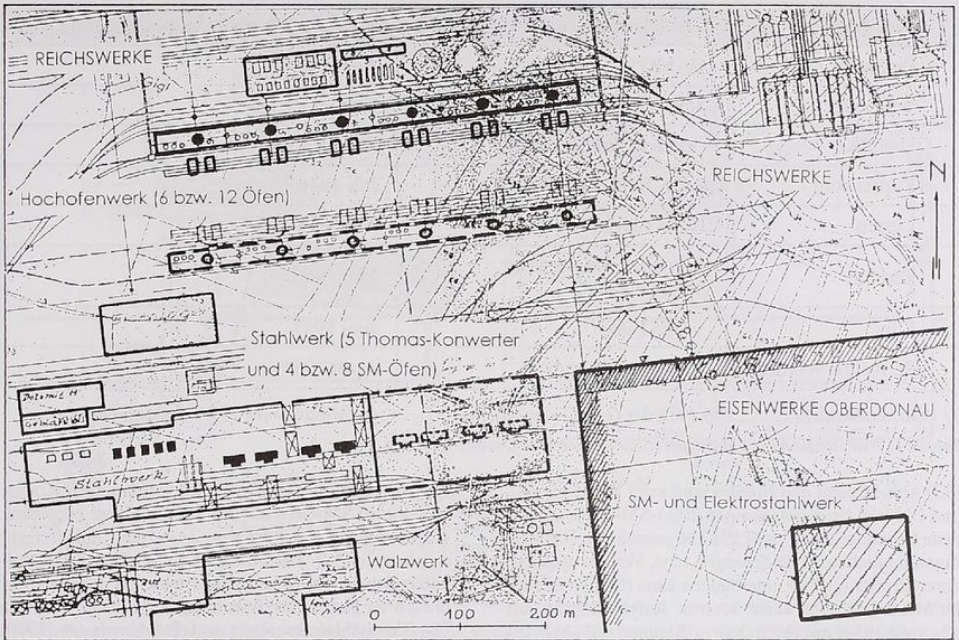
Hüttenanlagen der „Reichswerke“ und der „Eisenwerke Oberdonau“ in Linz (Stahlwerk und Walzwerk der „Reichswerke“ nicht gebaut). Ausschnitt aus dem „Lageplan Industriegebiet der Reichswerke Hermann Göring ...; Stadtbauamt Linz Mai 1938“; spätere Ergänzung mit den Eisenwerken Oberdonau. (Für die Wiedergabe geringfügig geändert.) Planarchiv des Geschichte-Clubs VOEST, Linz
